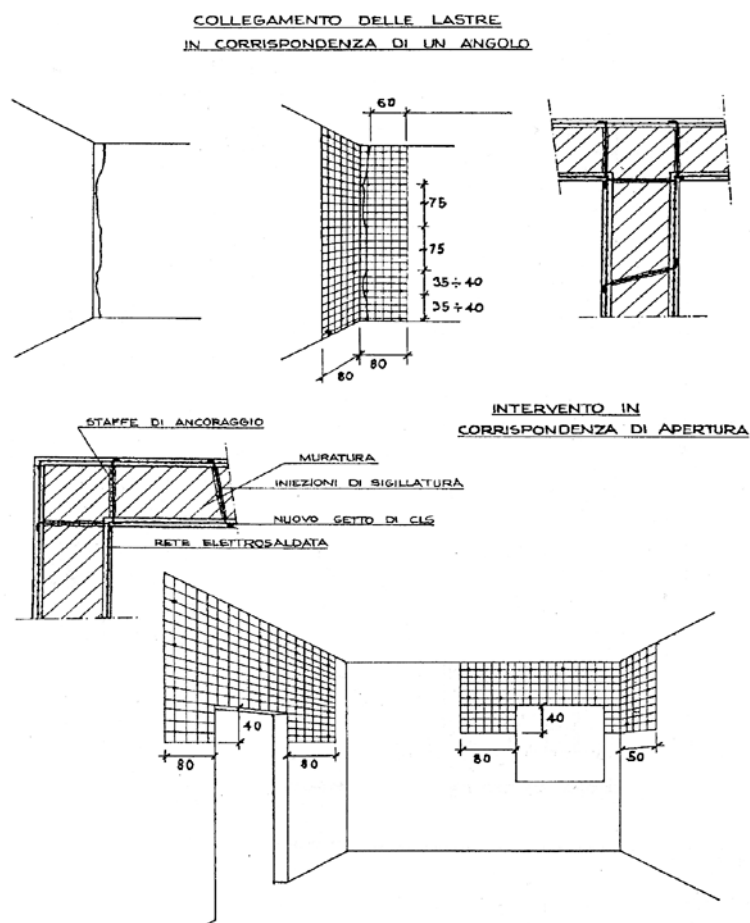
Risanamento e rinforzo della muratura mediante reti elettrosaldate e betoncino (13).
